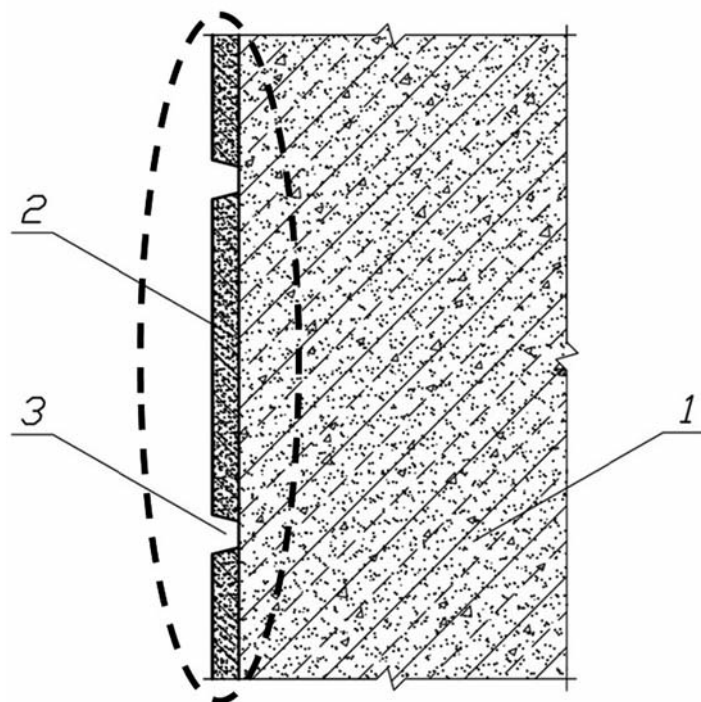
Конструктивная схема устройства стыков несъемной опалубки из тонкостенных фибробетонных элементов:
